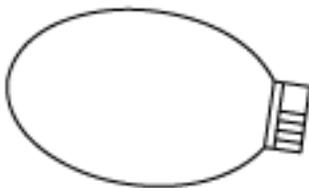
Schematischer Grundriss Skaterhalle
